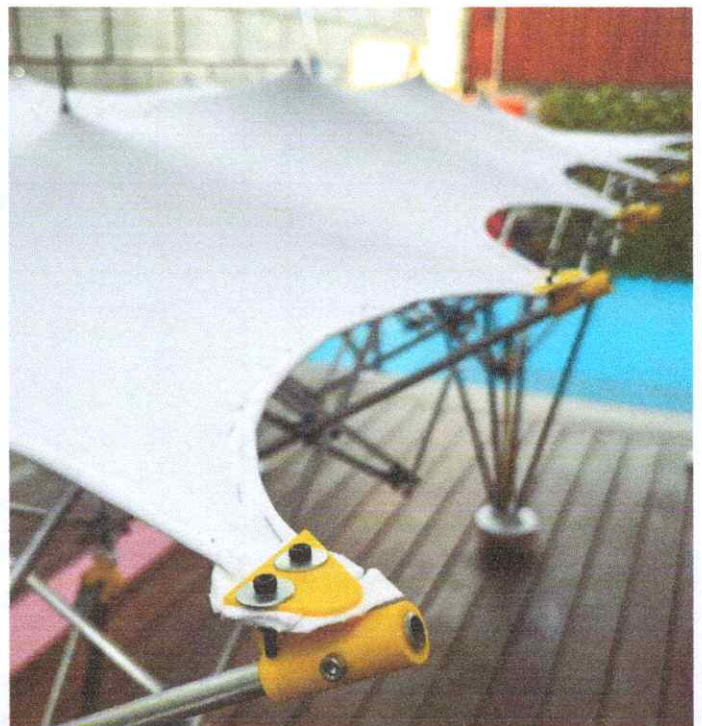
Detalles de ensamblaje de cubierta a estructura plegable
